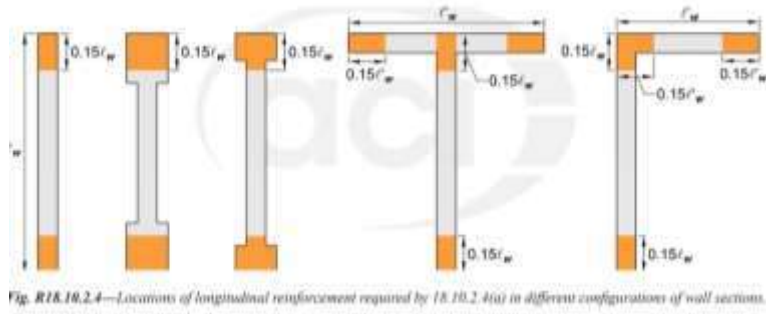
Ubicación de refuerzo longitudinal mínimo en extremos de muro.
